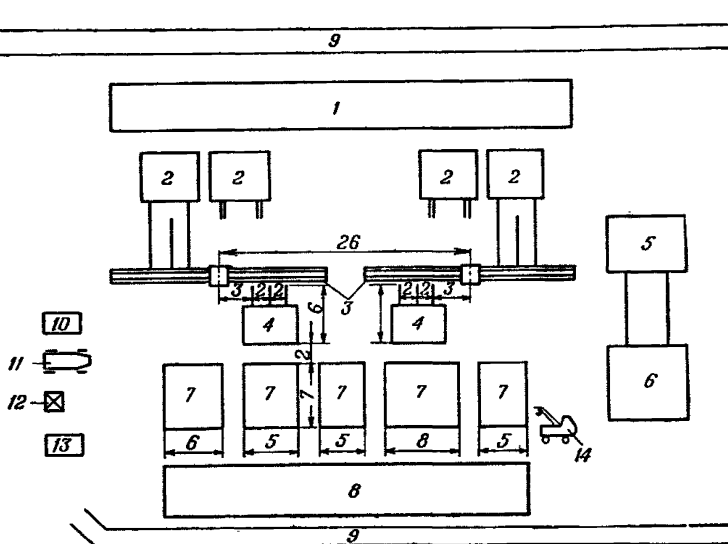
Схема расположения лесозавода и площадок для изготовления мостовых конструкций:
